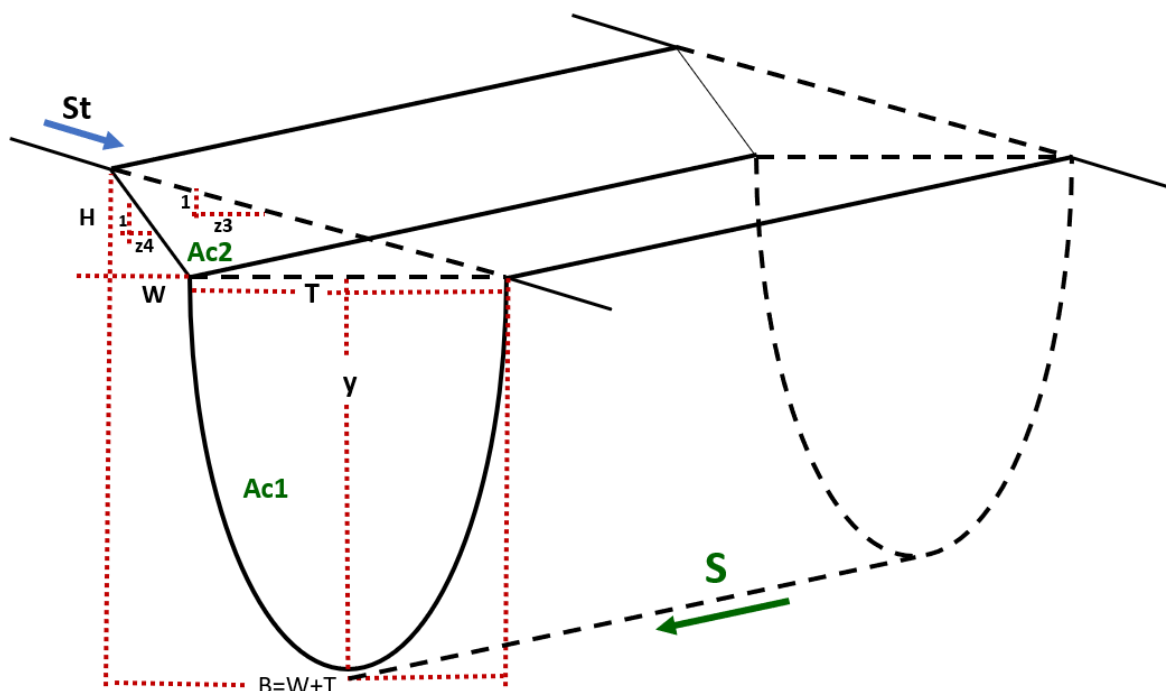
Acequia de ladera con sección parabólica según con talud en la pared del terreno donde se construye
